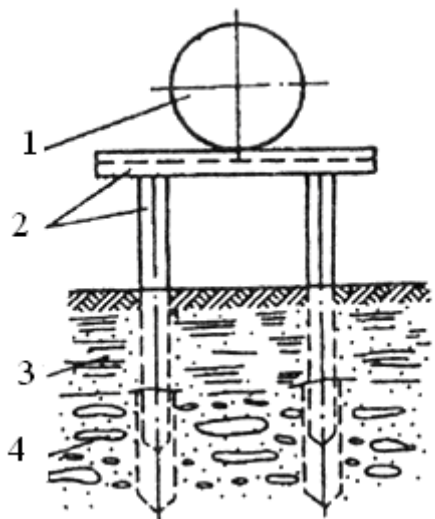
Схема надземной прокладки газонефтепроводов:
